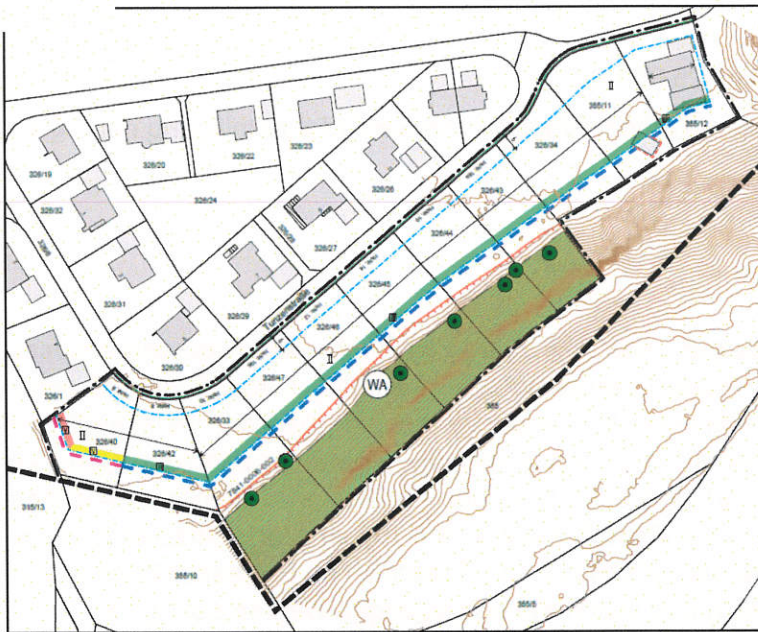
2. Änderung Bebauungsplan "Offenham", Fassung vom 08.11.2017
